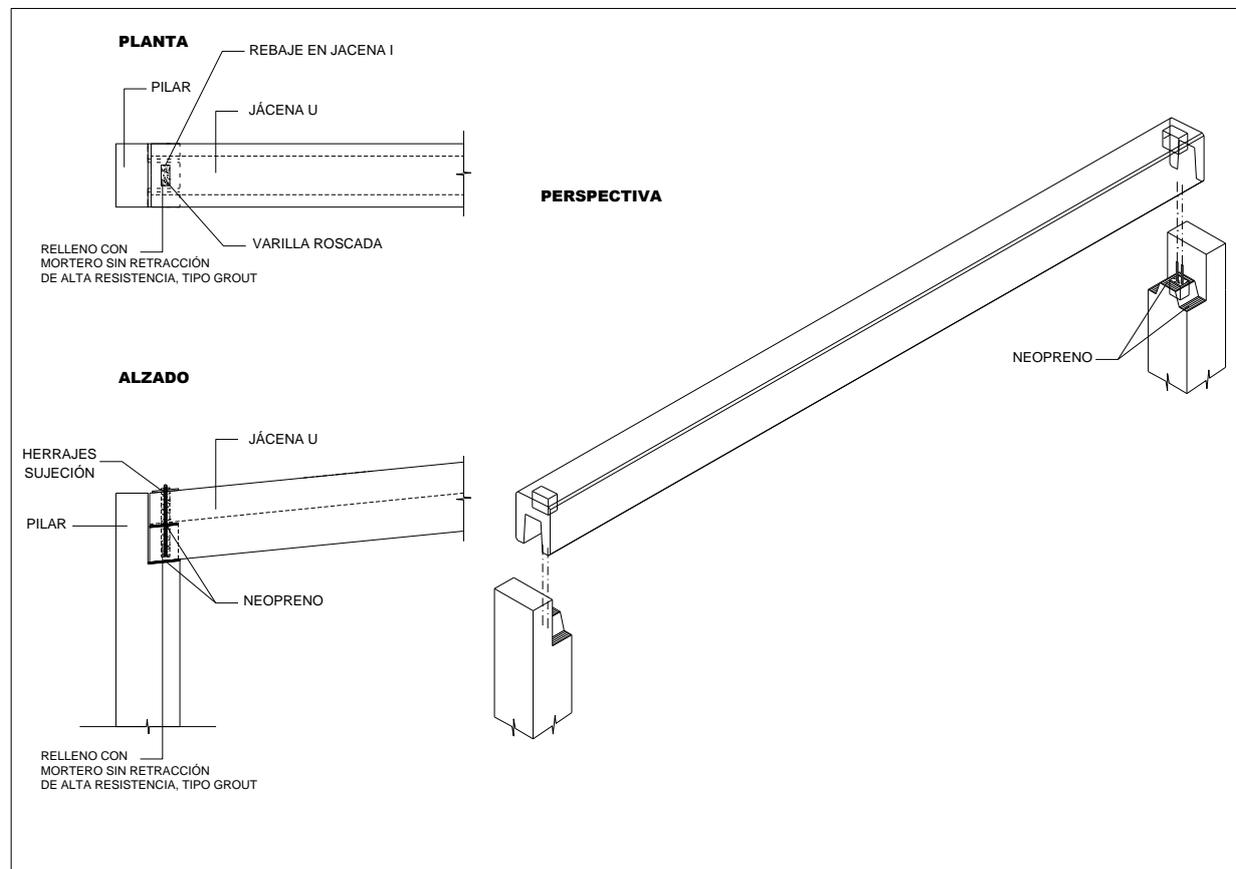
Unión pilar - canalón FUTURA tipo U para zona sísmica
